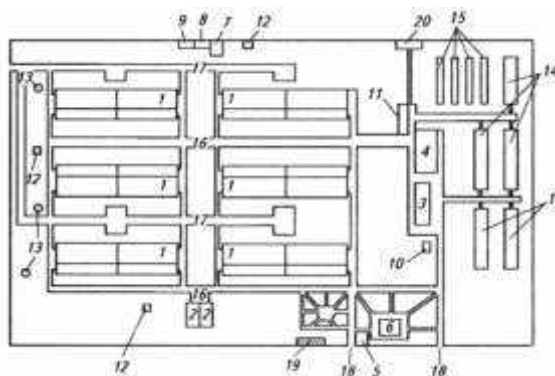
Генеральний план кроликоферми на 1800 основних маток
